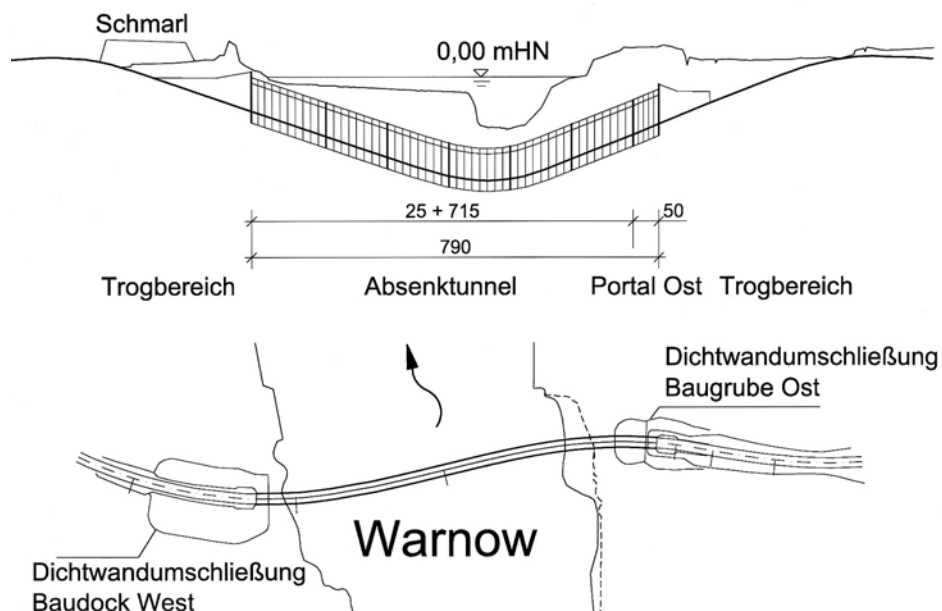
Warnowquerung, Längsschnitt und Grundriss
